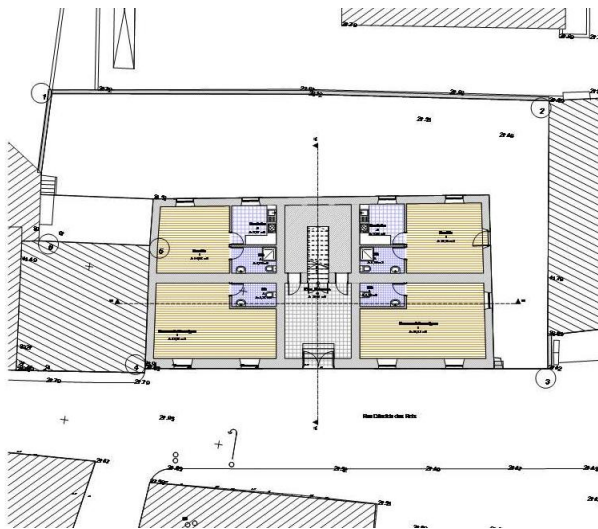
Planta do R/C, Proposta, Autor, 2017
